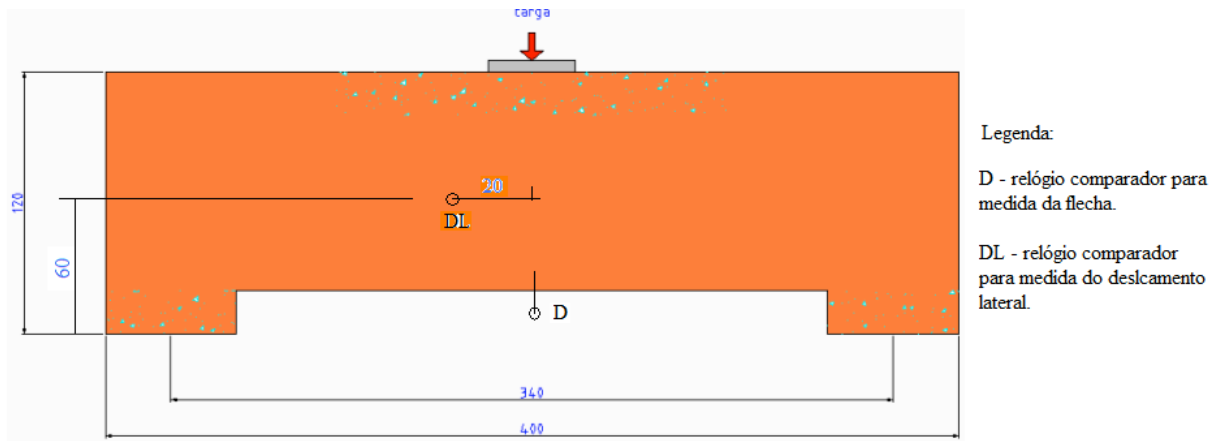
Dimensões e esquema de ensaio das mini-paredes com 400 cm de comprimento (medidas em centímetros) – ensaio à flexão em três pontos.
